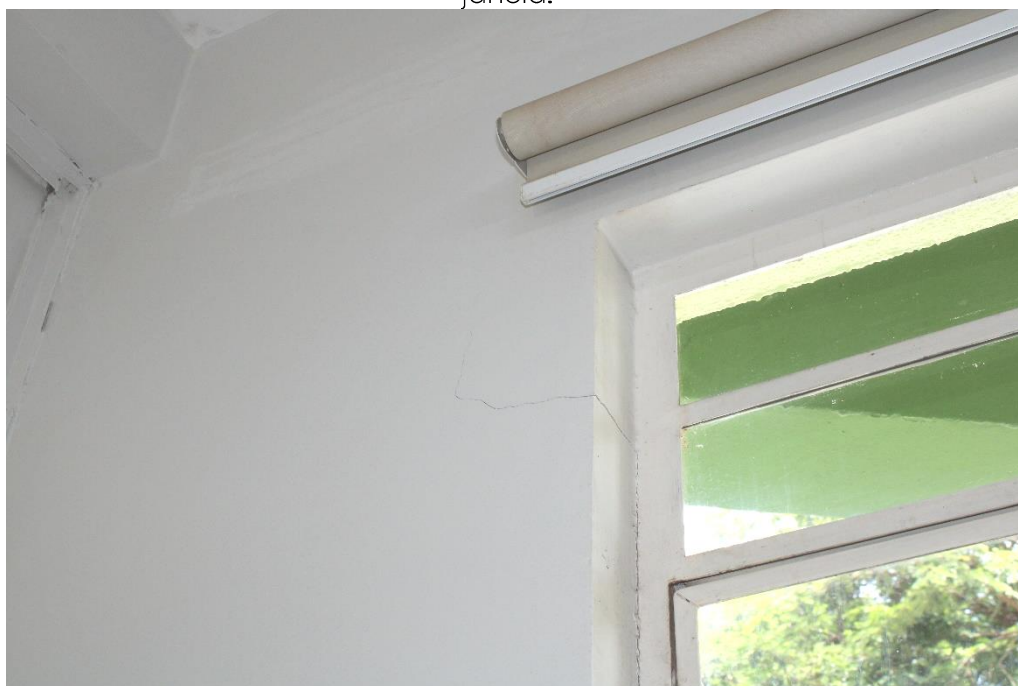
Em detalhe a foto acima, destacando fissura em alvenaria.
